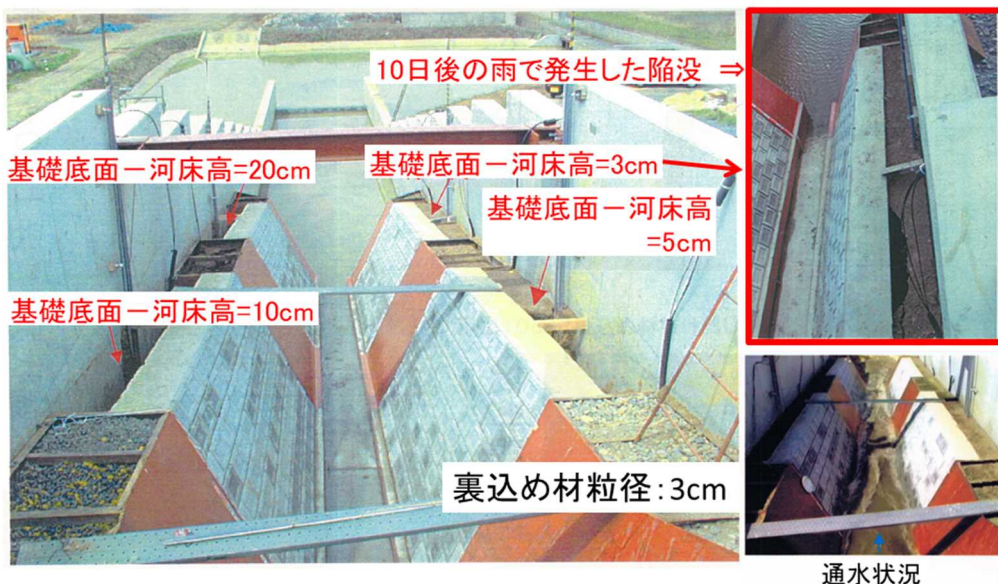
基礎洗掘吸い出し実物大実験 通水後
